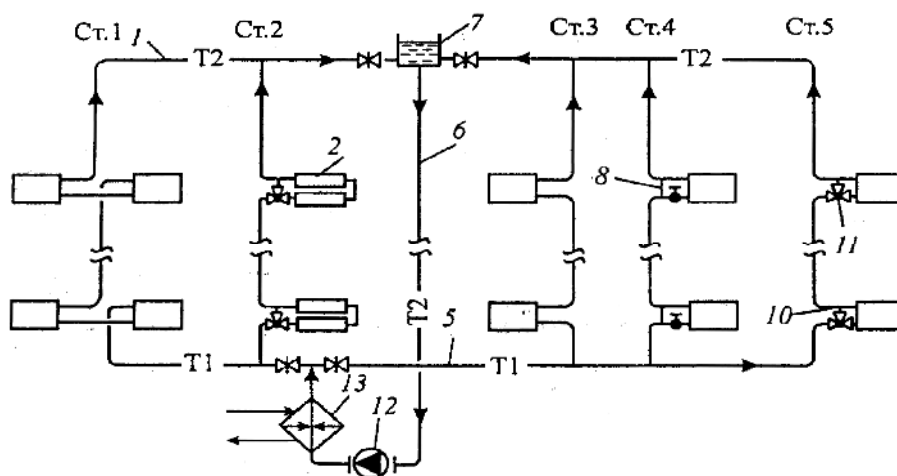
Схема вертикальной однетрубной системы водяного отопления с «опрокинутой» циркуляцией воды и проточным открытым расширительным баком:
